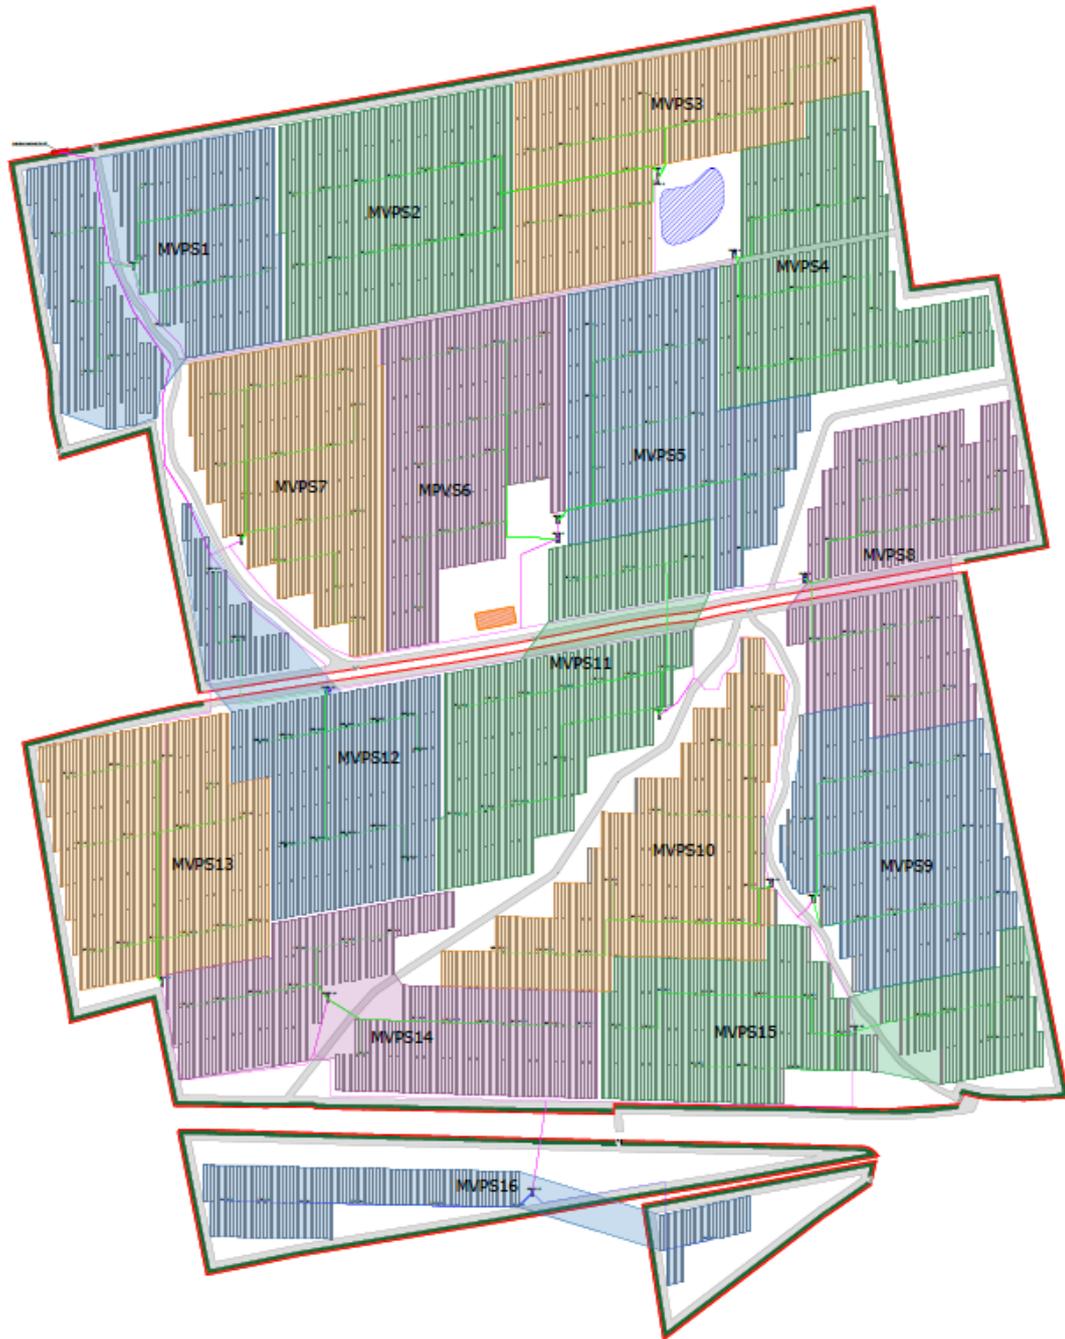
Layout di impianto con evidenza sottocampi e collegamenti inverter
